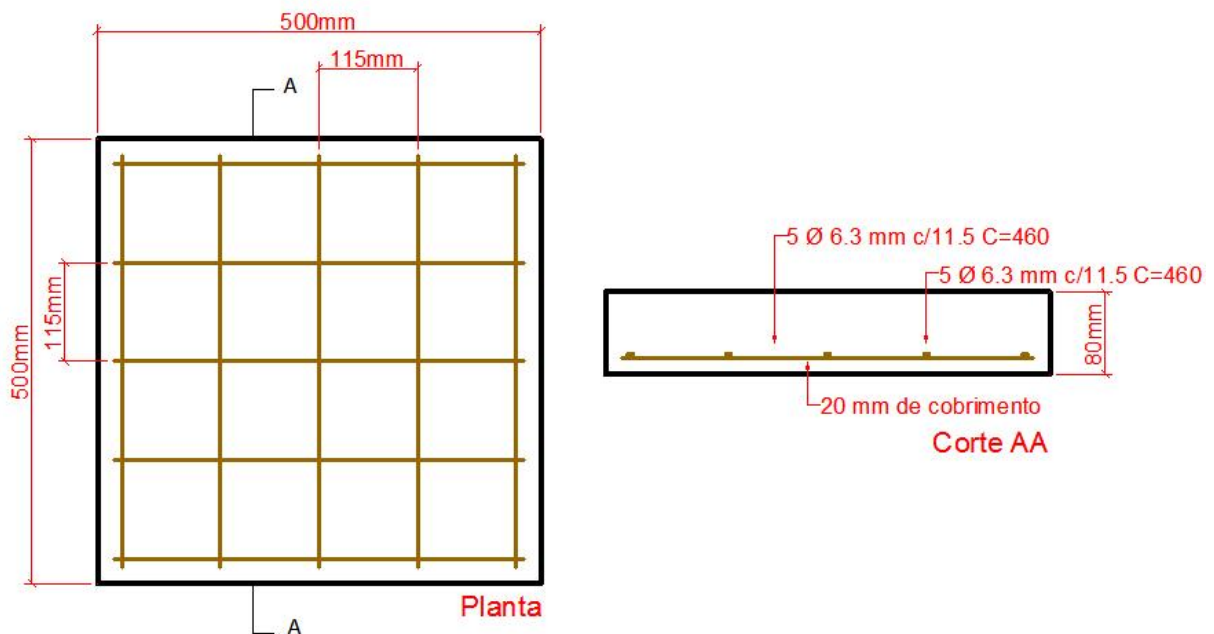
Detalhamento da armadura usada nas placas de concreto
